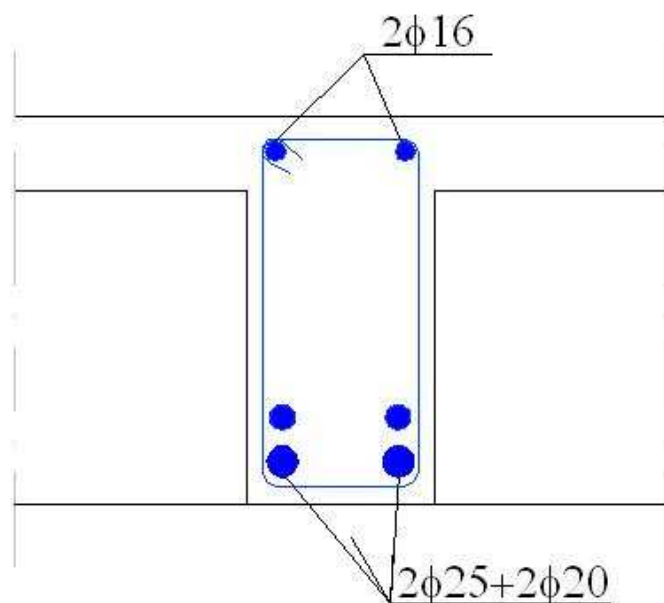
Corte da laje com armadura inferior das nervuras na direcção "x".
